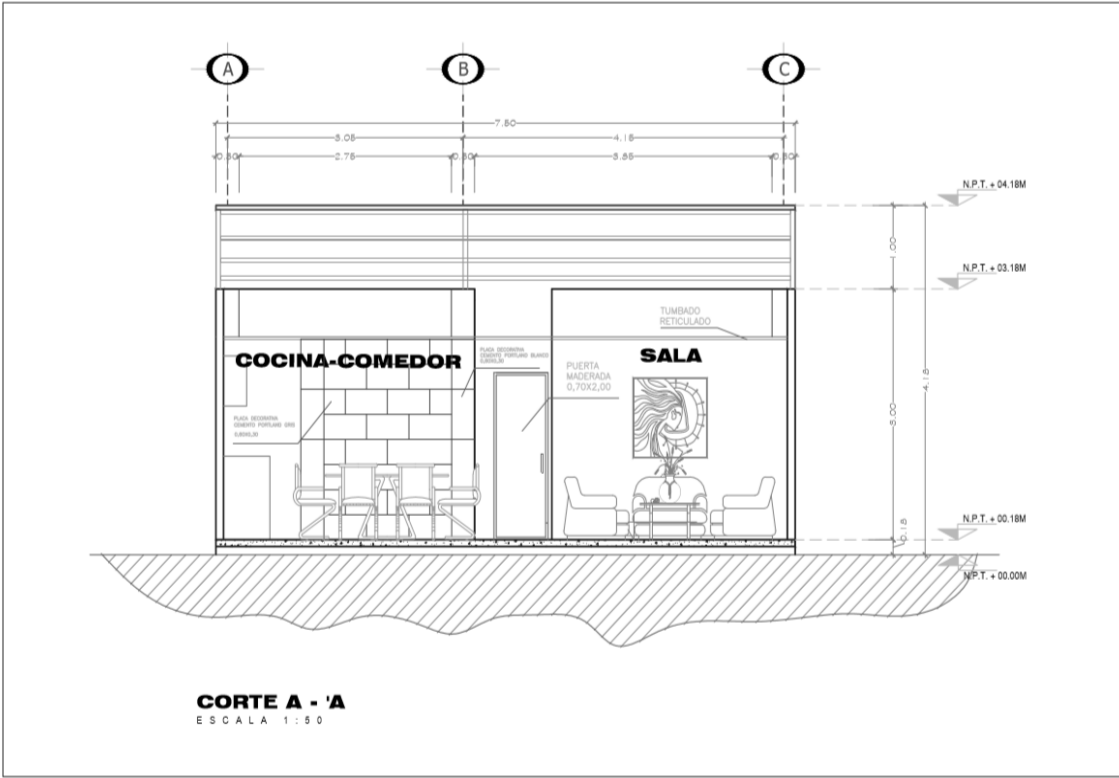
Plano Arquitectónico - Corte Cocina/Comedor
